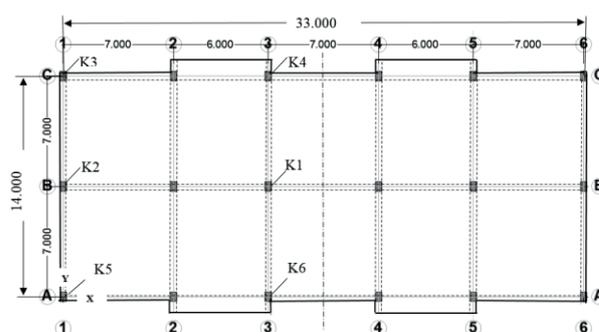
План типового этажа, исследуемого монолитного каркасного здания с кирпичными стенами заполнения
